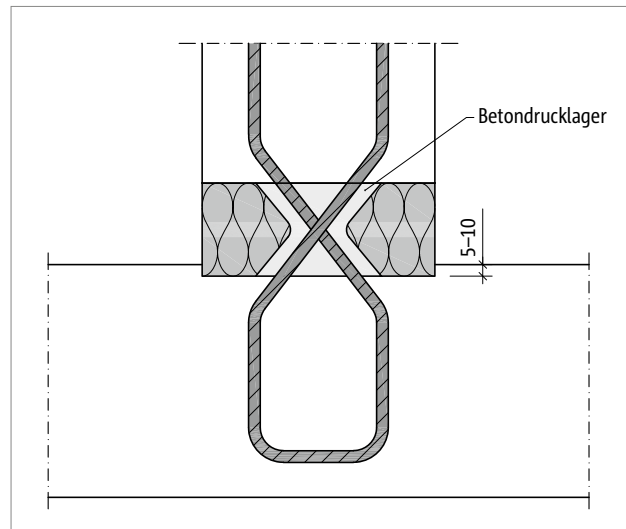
Schöck Sconnex® Typ W: Detail 1; Formschluss durch 5–10 mm tiefe Einsenkung des Dämmkörpers in die Decke
